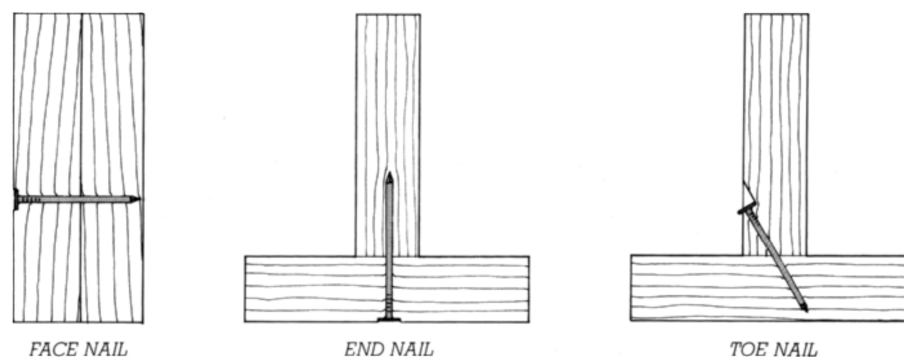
Tipos de pregação. [Allen e Thallon (2011)]
